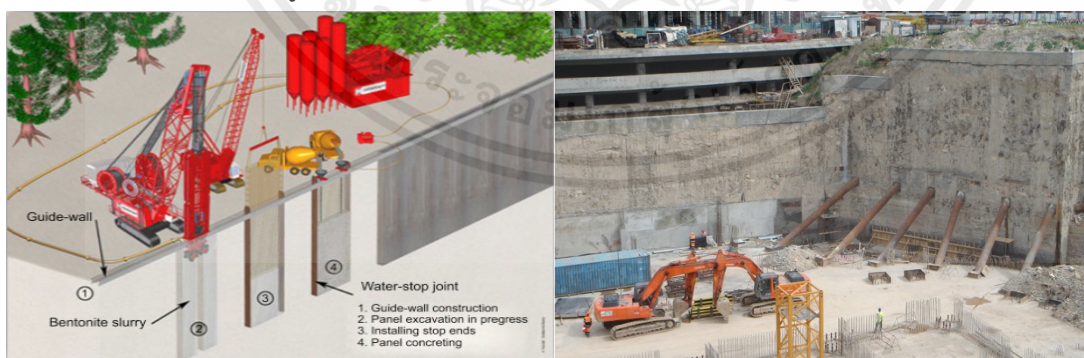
กำแพงกันดิน Anchored wall
